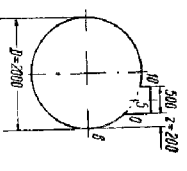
Вид горизонтальной оси 0-5-10 на резервуаре.
